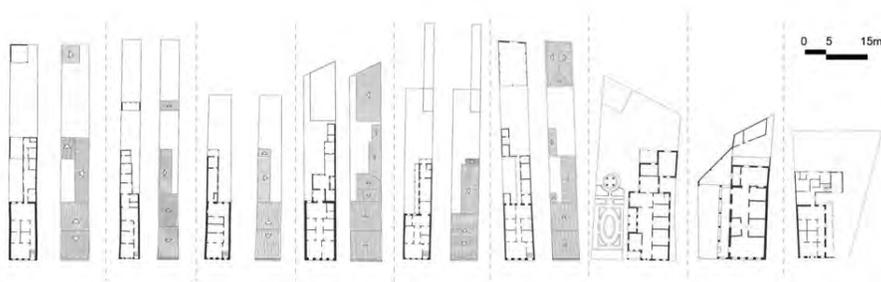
Tipologias de planta no conjunto urbano de Areia/PB.
